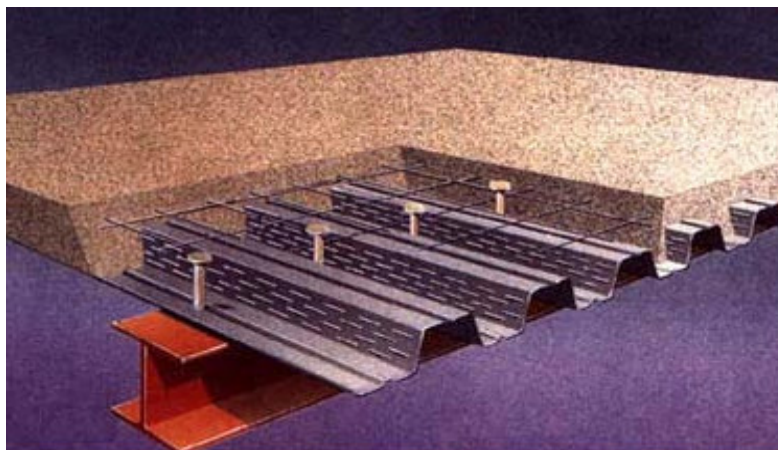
LAJE MISTA AÇO-CONCRETO
